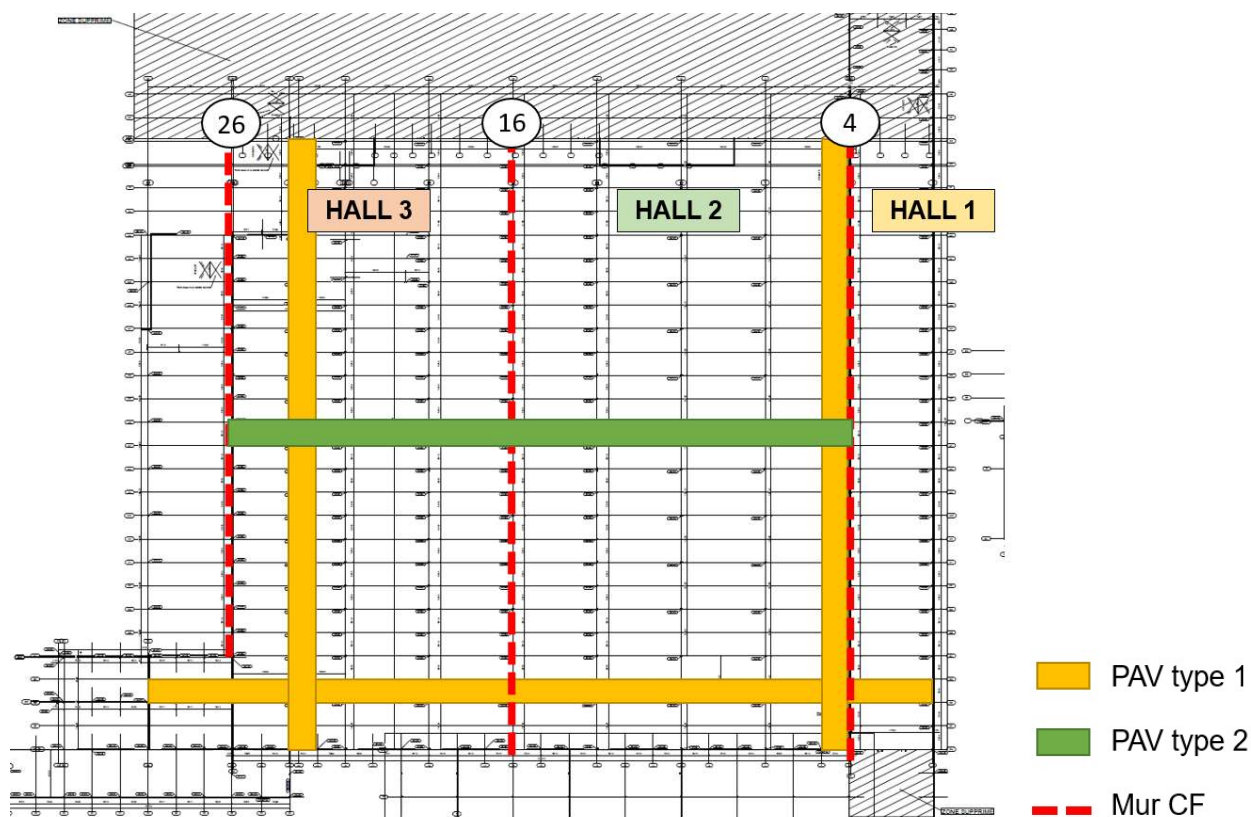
Emplacement des poutres au vent – Halls 1 à 3
